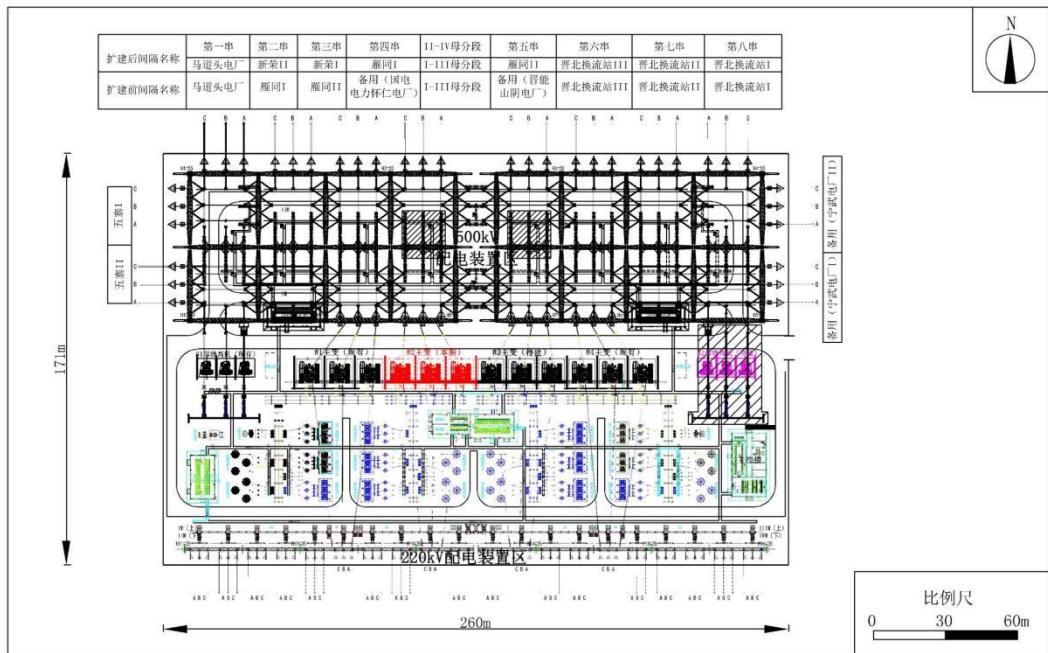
平鲁 500kV 变电站平面布置示意图
